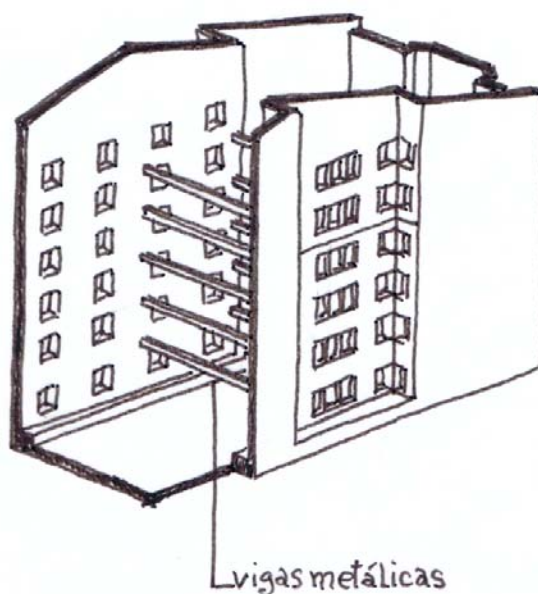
| Esquema de reforço dos pavimentos com vigas metálicas (adaptado de [11]):
